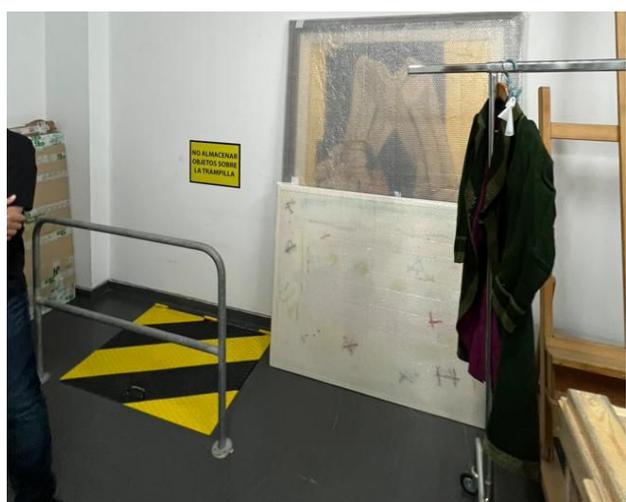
Vista desde Planta Baja: Trampilla a Sótano Existente
